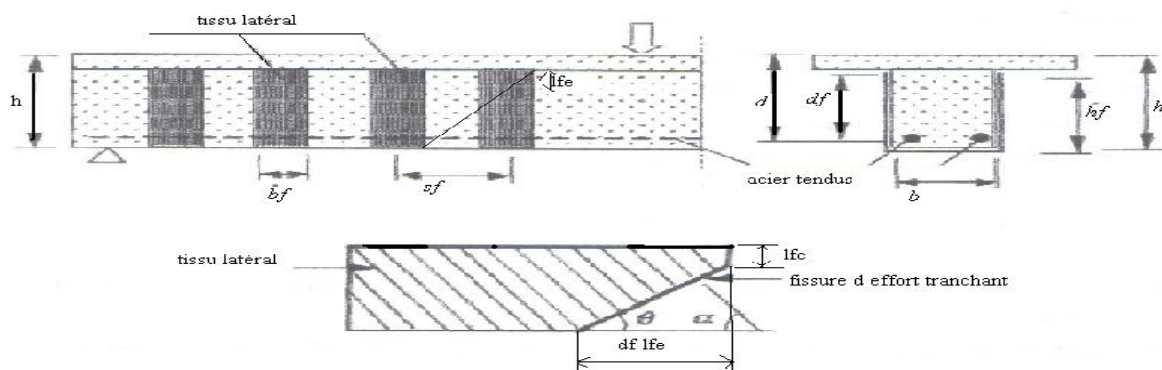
Schéma des paramètres d'une poutre renforcée latéralement
